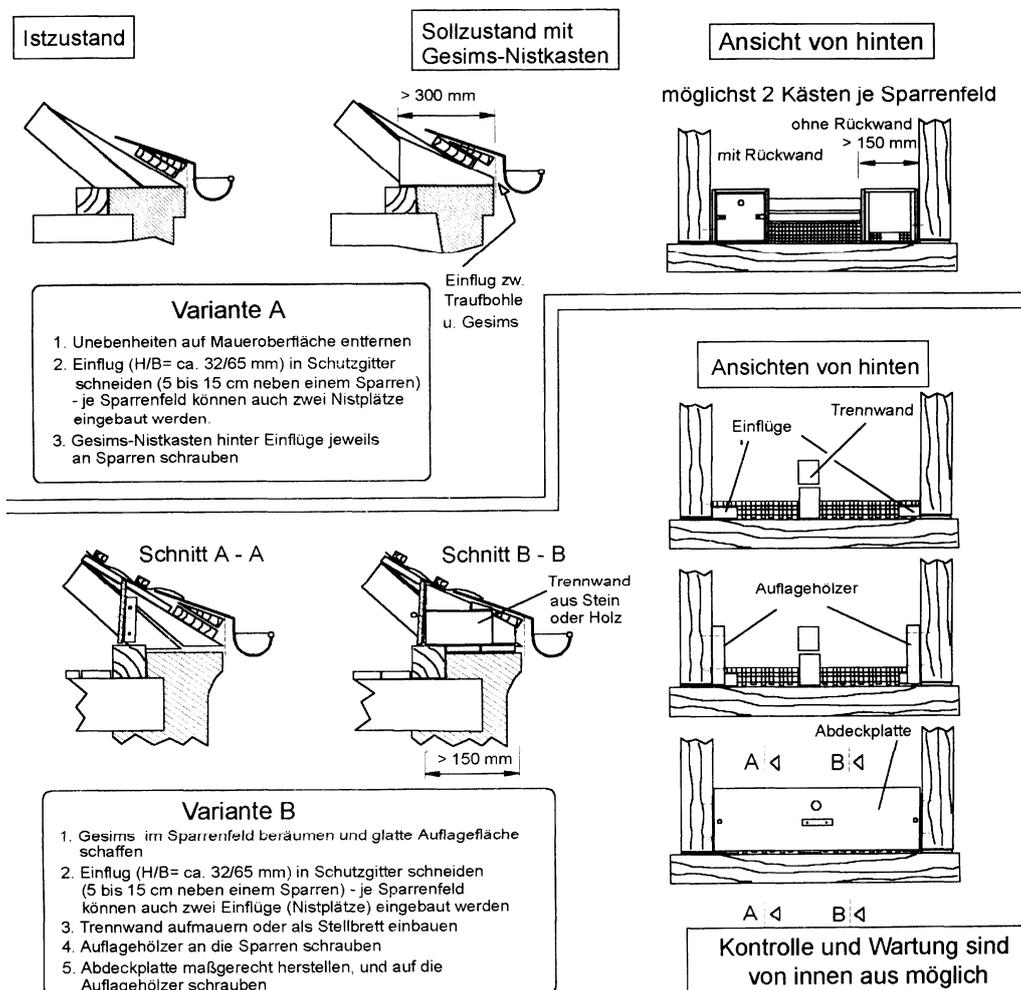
Niststätten im Steingesimsbereich mit nicht ausgebautem Dachboden insbesondere für Mauersegler und Haussperling
